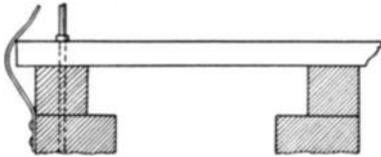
Befestigung des einfachen Bohlenbelages auf Längsbalken.
